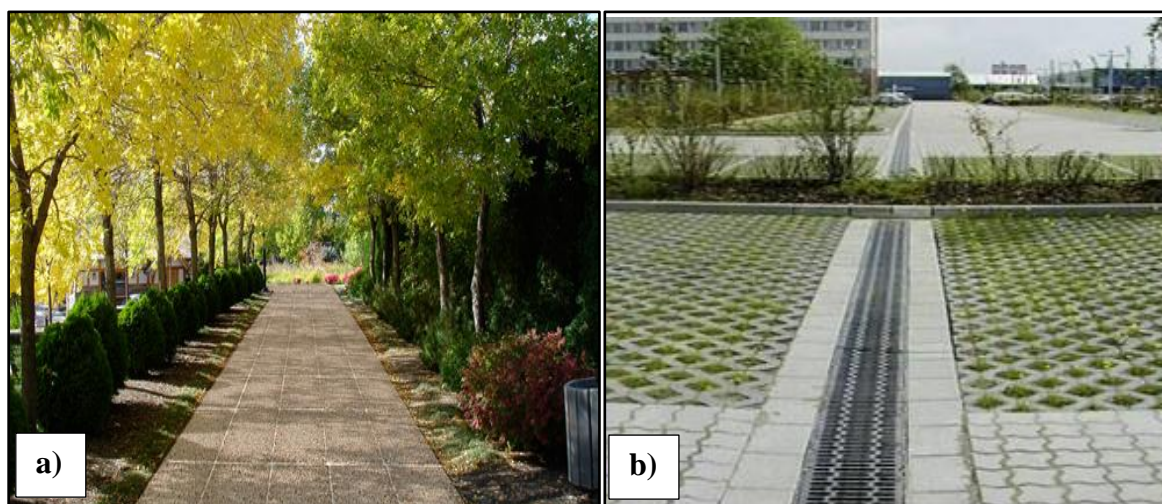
a) Aplicação de pavimentos permeáveis em parques. b) Pavimento permeável aplicado em um estacionamento.
